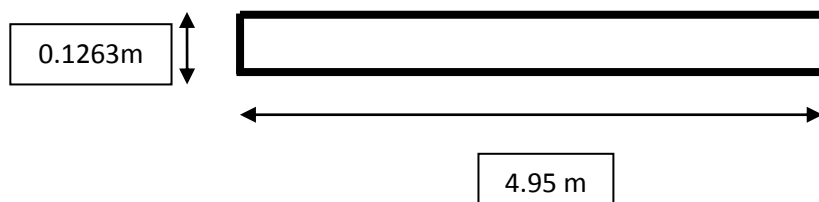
Detalle de área a excavar para cimentación (fosa)
